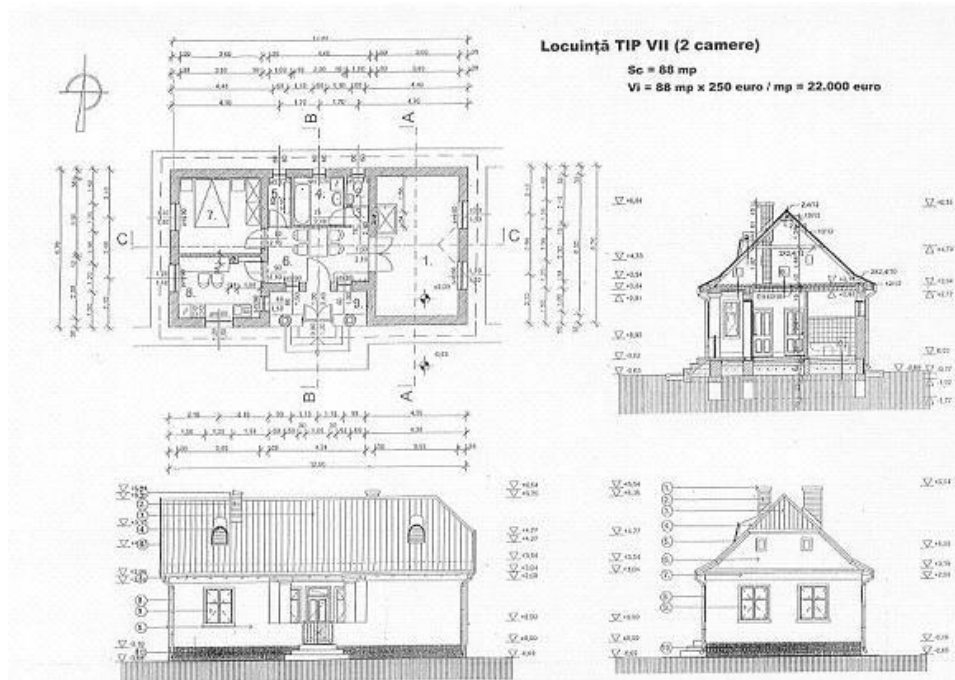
Plan locuință tip VII cu 2 camere ,S=88m²
